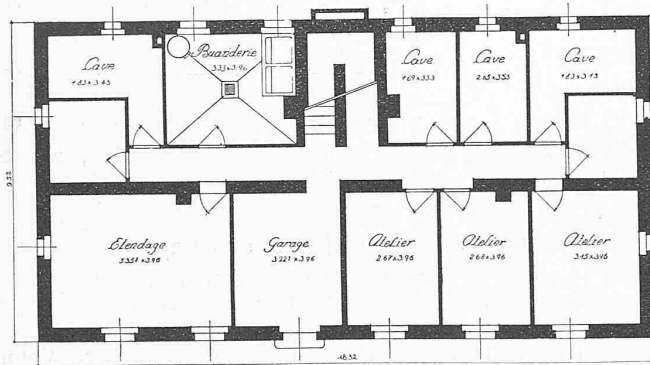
Kellergrundriss 1 : 200. — Wohnhaus für sechs Familien, Typ C. — Abb. 8. Wohngeschoss 1 : 200.
